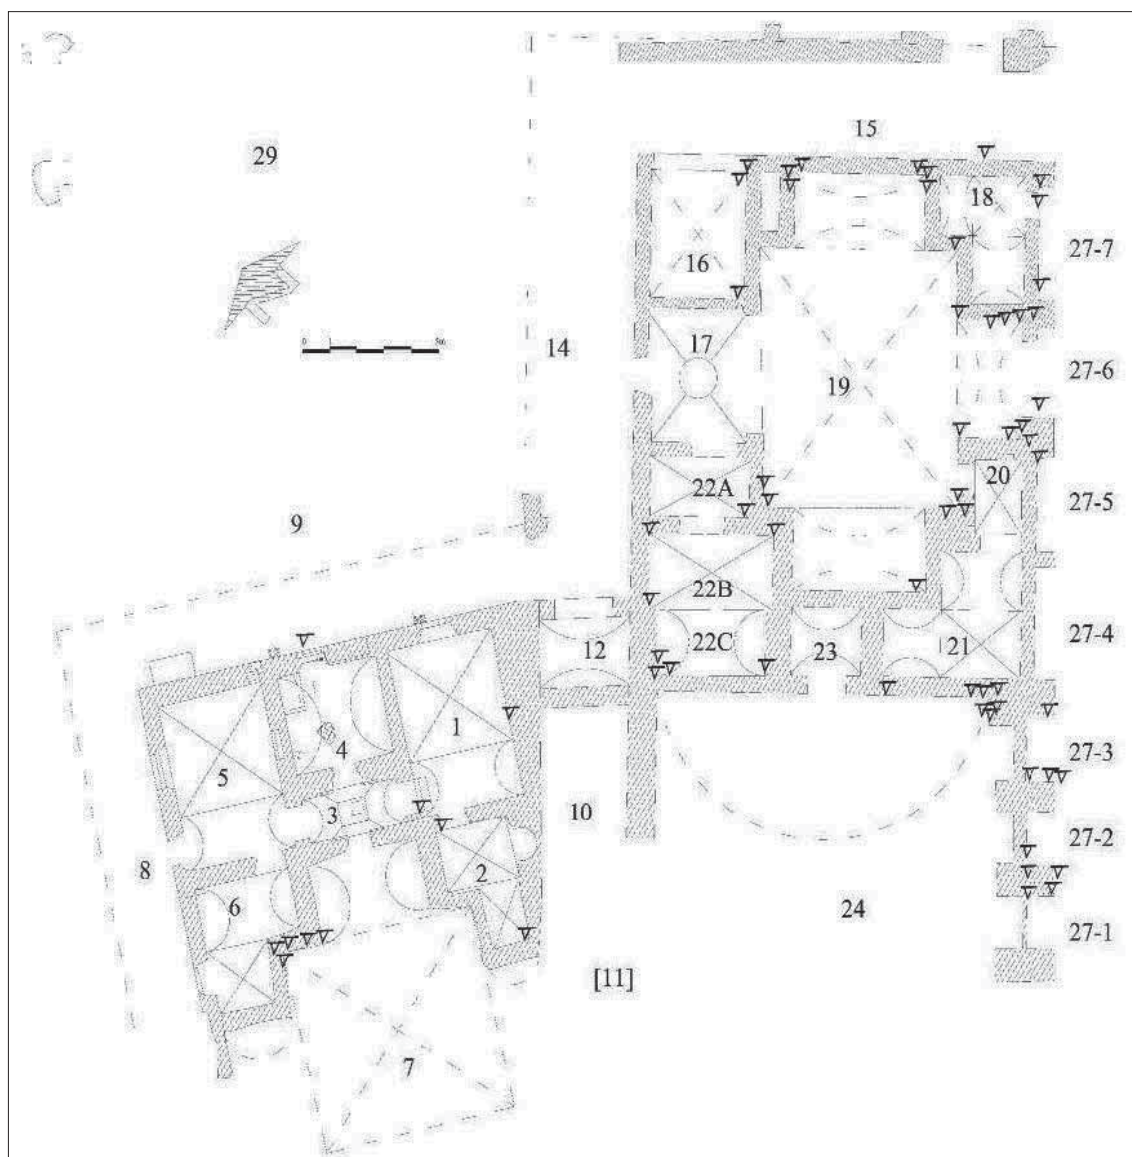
Palestra, pianta con la localizzazione dei segni rossi.
